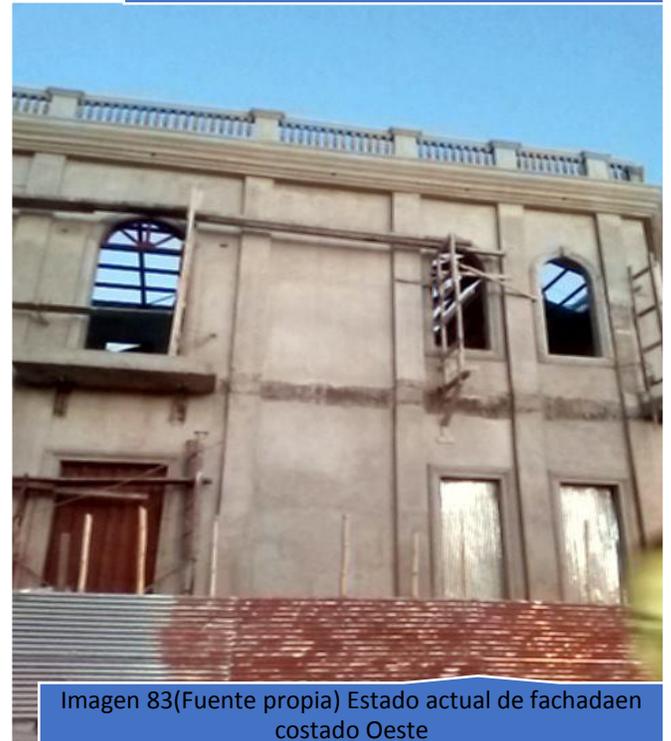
(Fuente propia) Estado actual de fachada en costado Oeste
